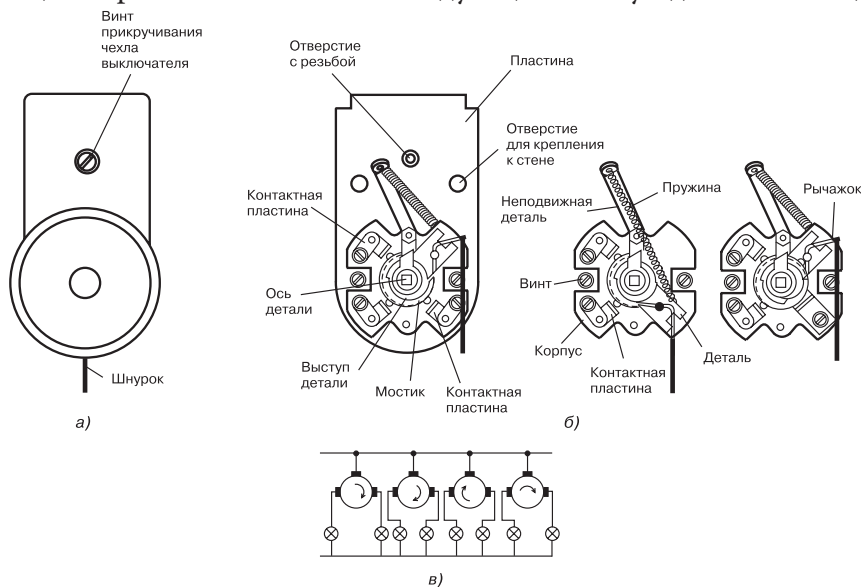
Подпотолочный переключатель со шнуровым приводом для открытой установки
